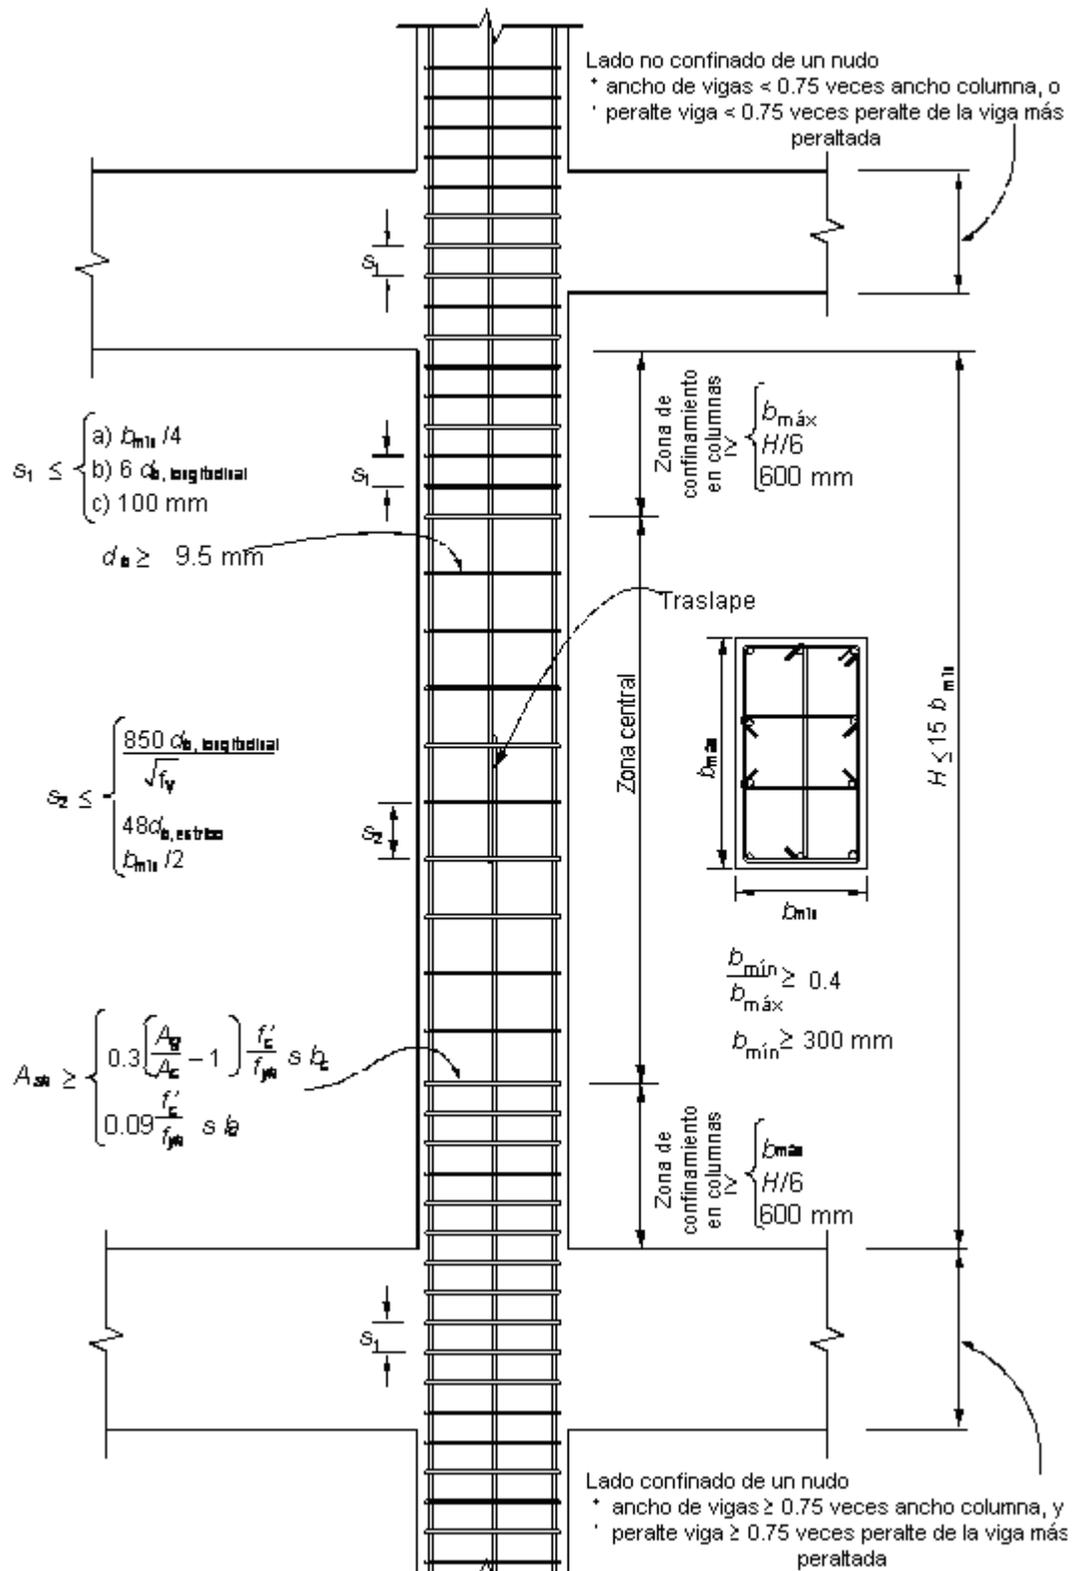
Detalle recomendado en columnas que son parte de los marcos dúctiles.
